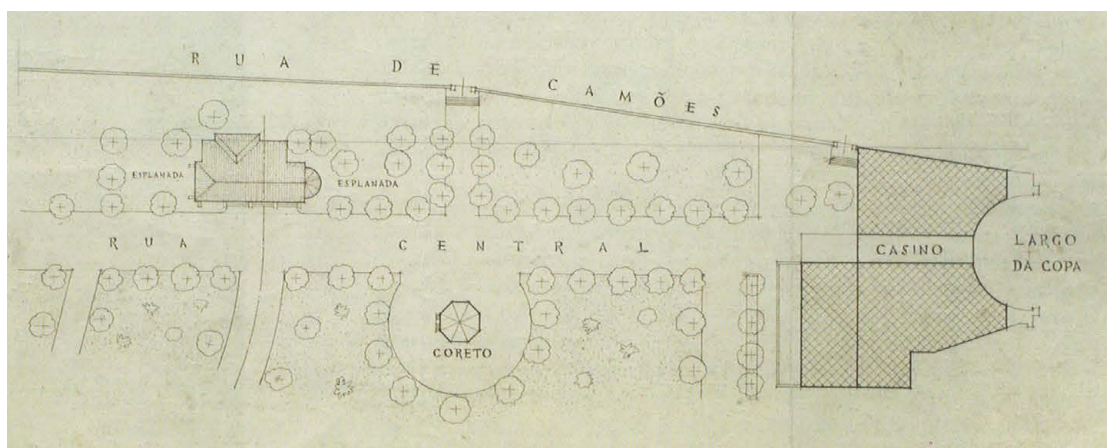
Caldas da Rainha, Planta do Parque • (Mangorrinha e Pinto, 2009)
